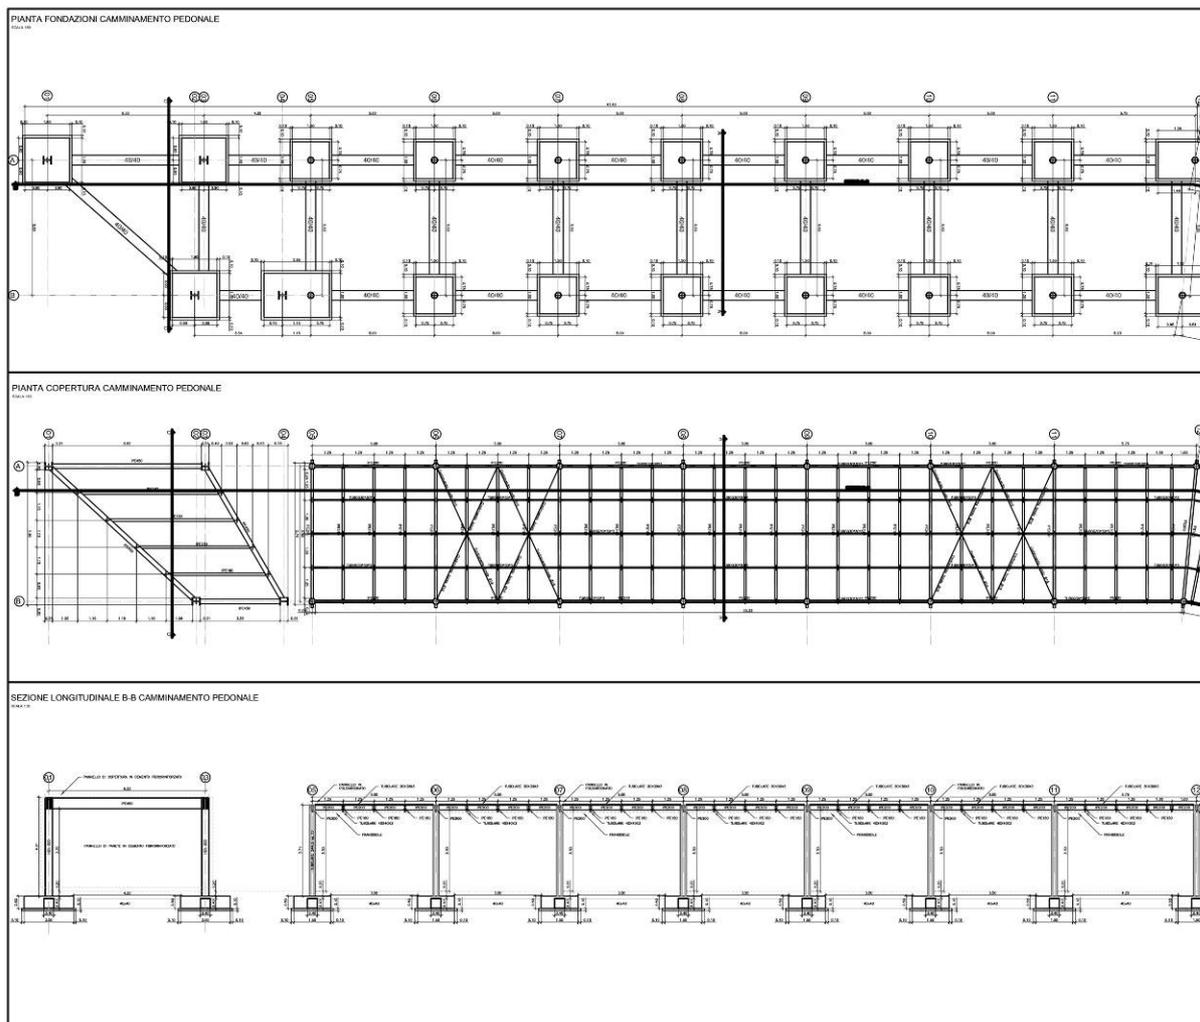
Pianta fondazioni, copertura e sezione longitudinale del camminamento pedonale
